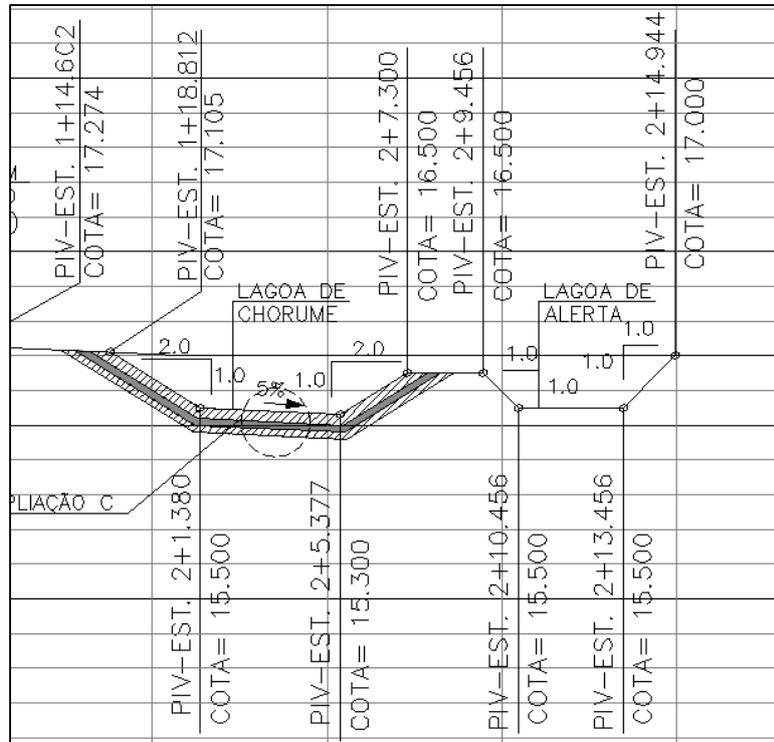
Seção em corte da lagoa de alerta e da lagoa principal de chorume.
